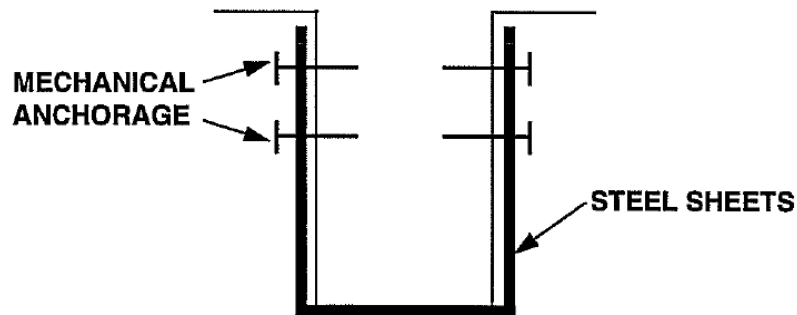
Anclaje planchas de acero (Aguilar et al., 1996).
